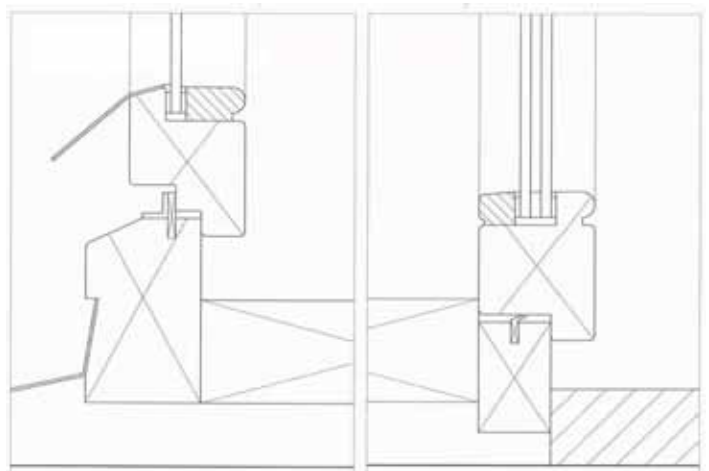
Vertikalfensterschnitt Maueranschluss unten
